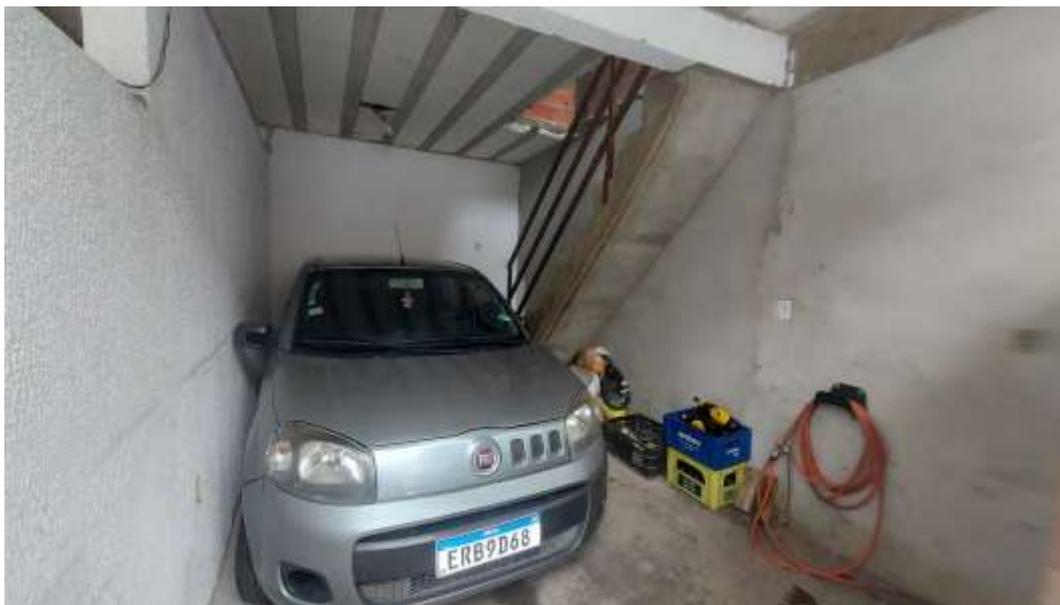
Garagem-Térreo (com acesso para o primeiro pavimento)
